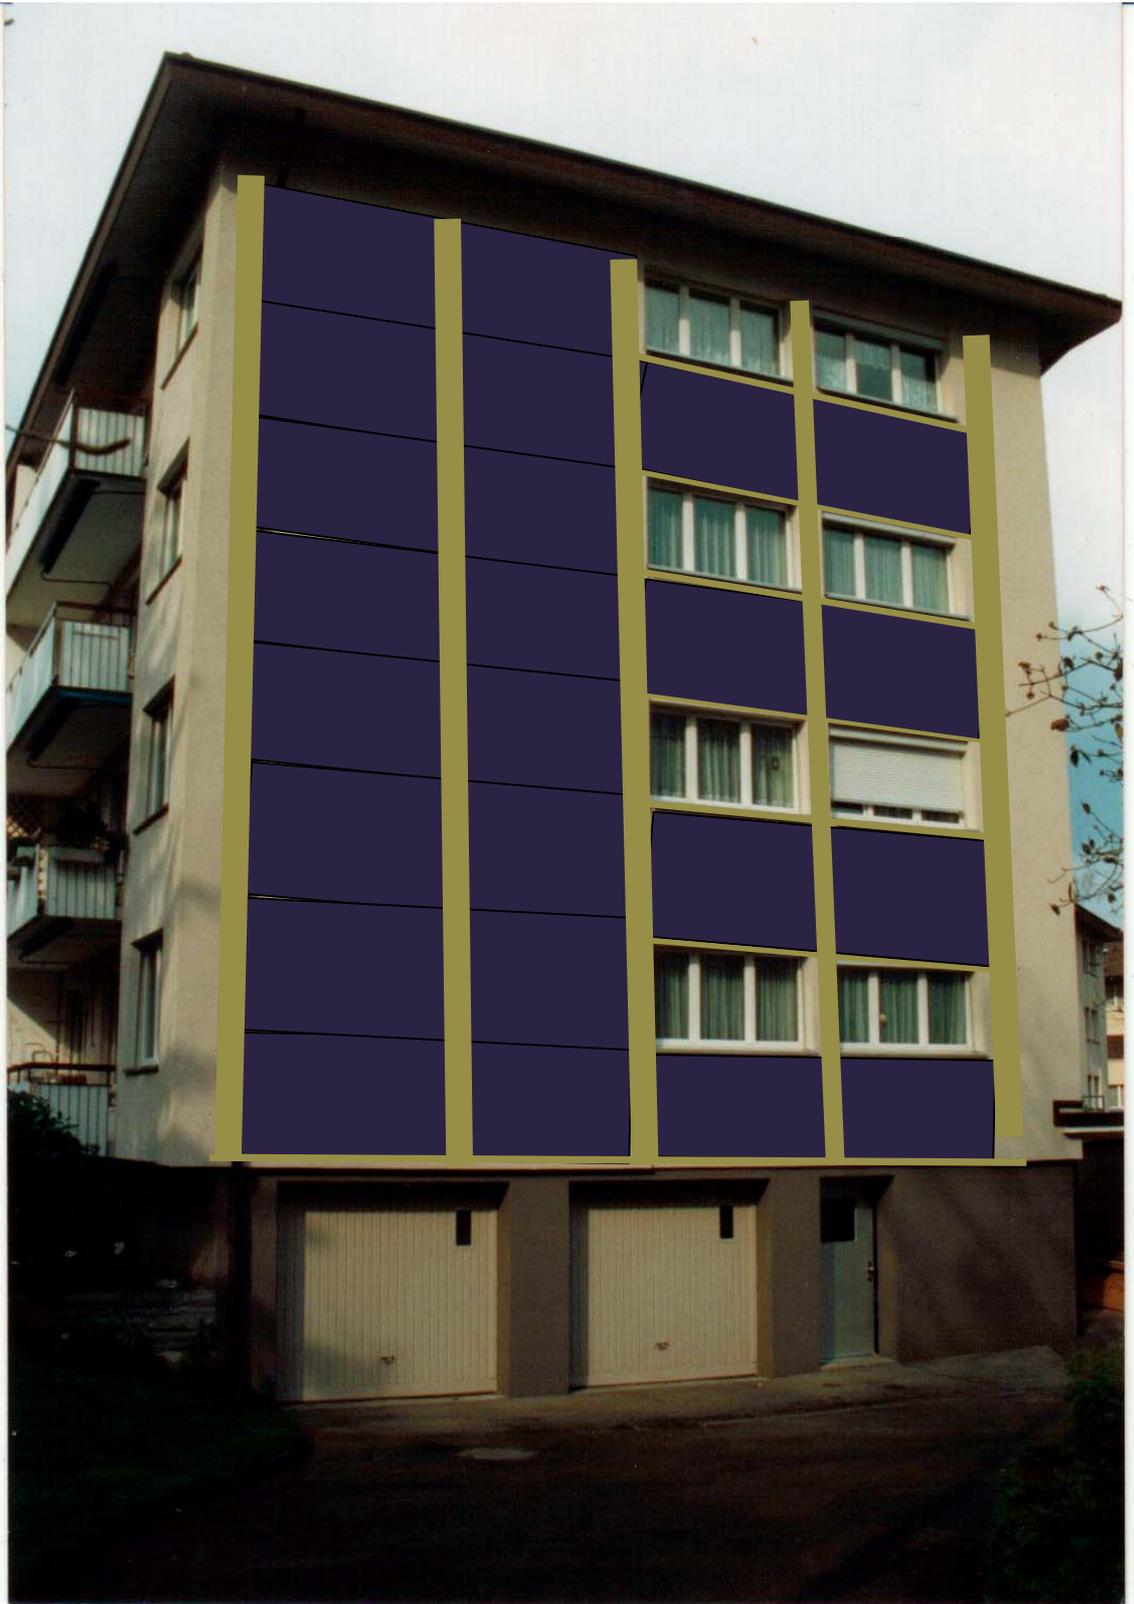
Musterlayout (Fotomontage) für ein zu sanierendes Mehrfamilienhaus.
